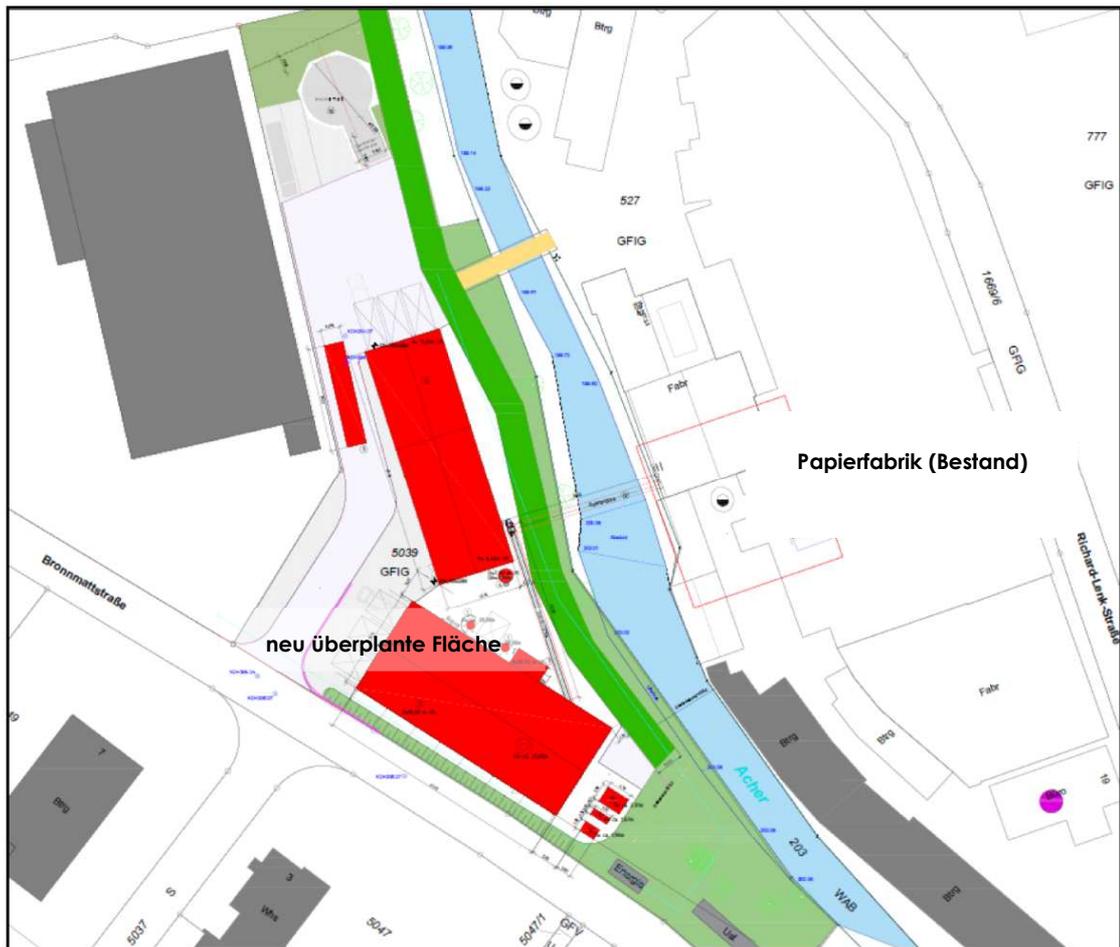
Übersichtslageplan [Quelle: Vermessungsbüro Gerber / GETEC]
